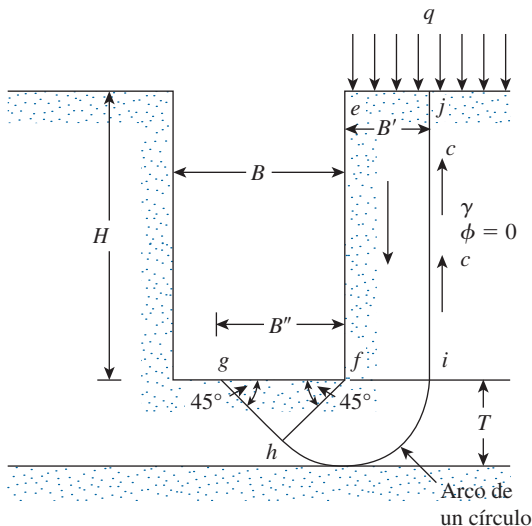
Levantamiento en cortes apuntalados en arcilla.
